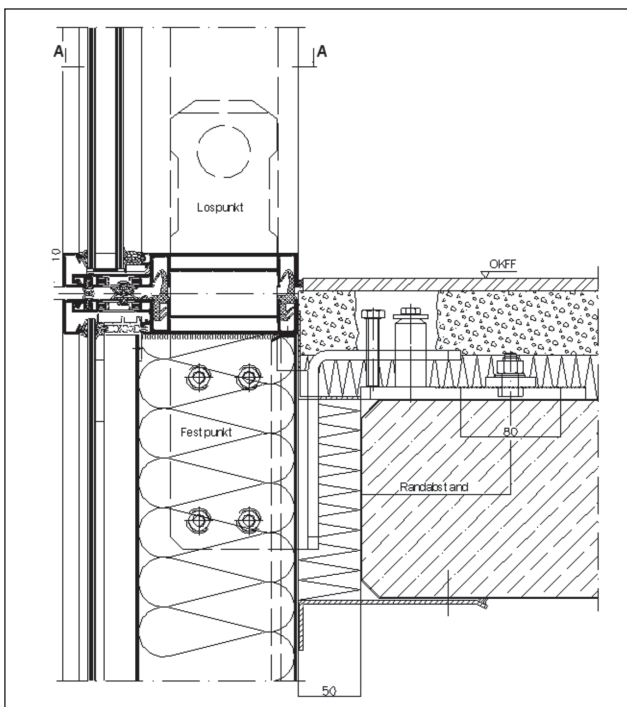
Fassadenkopplung nach dem Zusammenfügen – Vertikalschnitt
